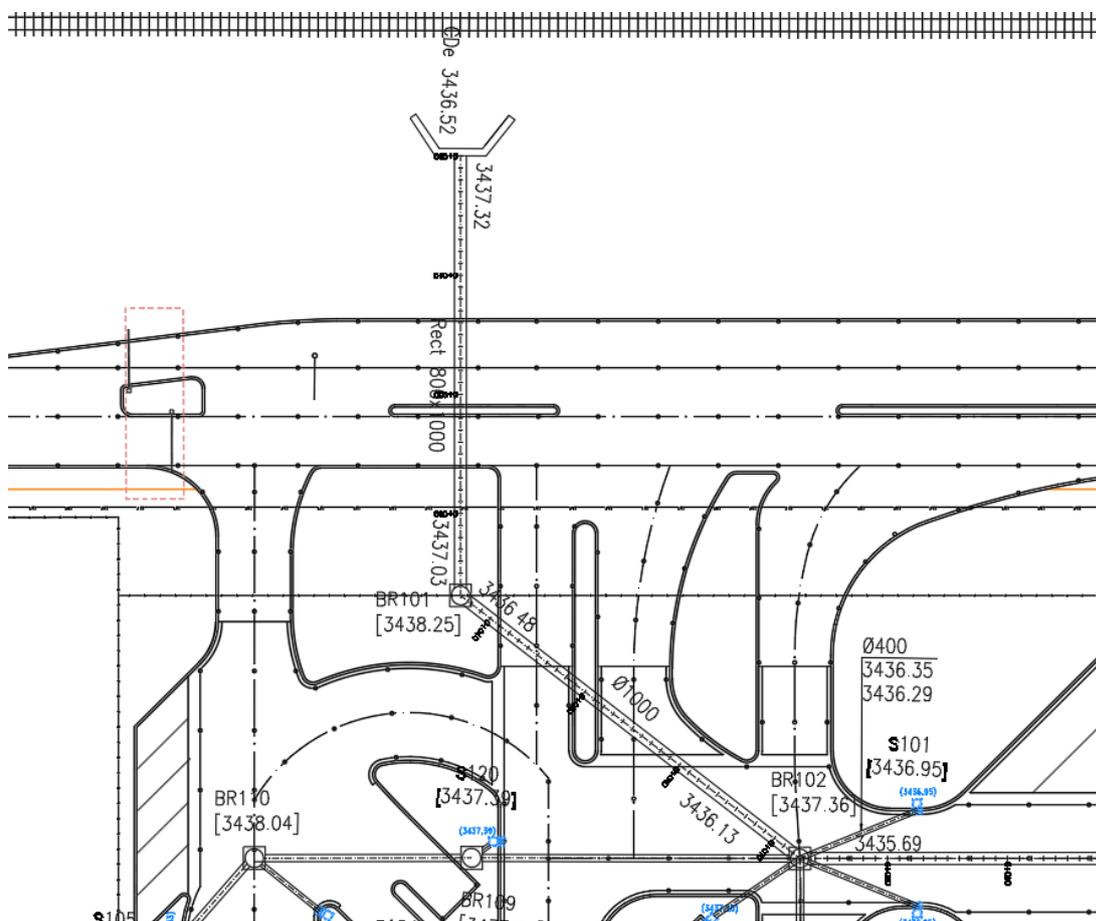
Drenajes cuenca exterior a través de la avenida Internacional sector 2 Paso Fronterizo La Quiaca.
